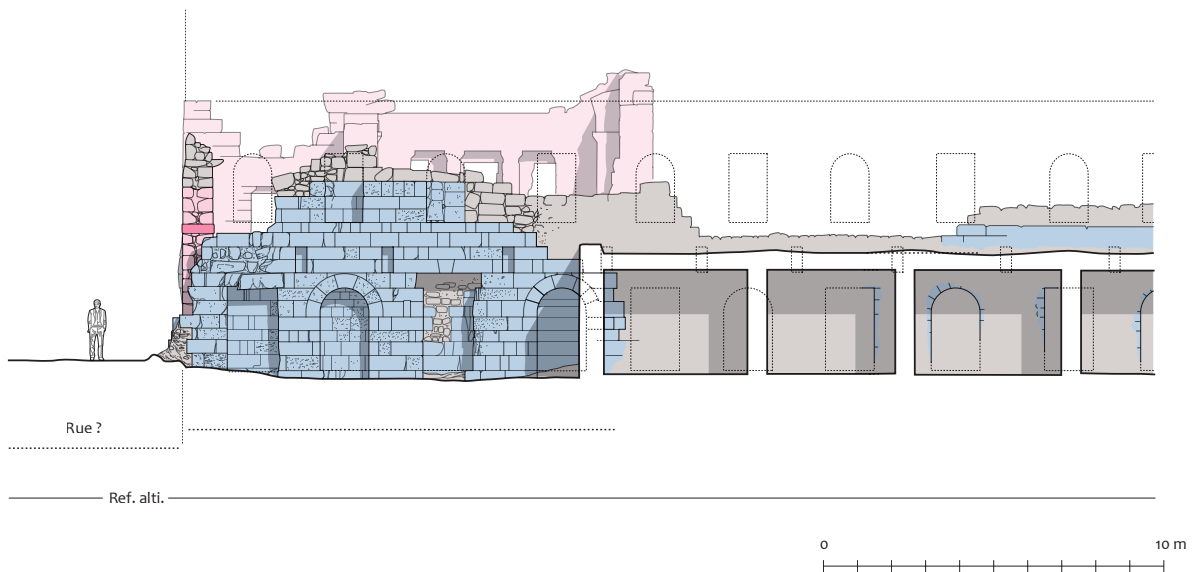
Le « Palais de Trajan », coupe 6, coupe-élévation nord-sud sur le mur à niches (bâtiment est), vers l'ouest. Étapes de construction et chronologie
